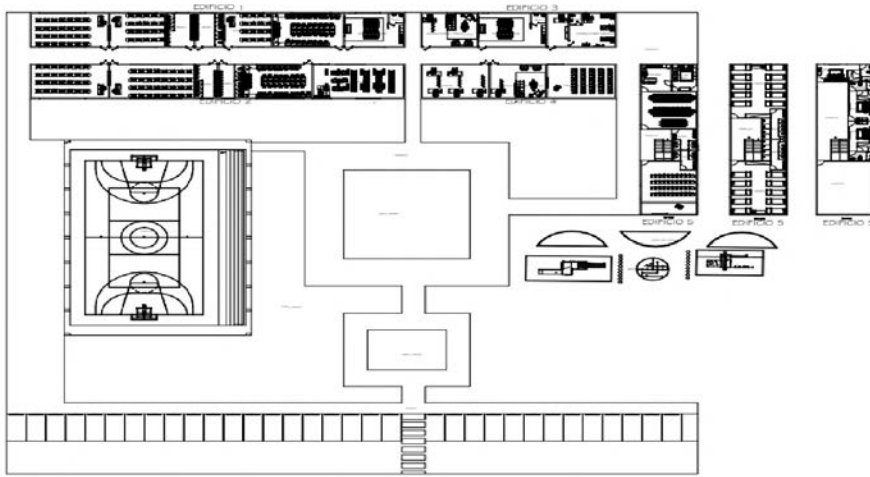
Planta dimensionada de conjunto - Creación propia
